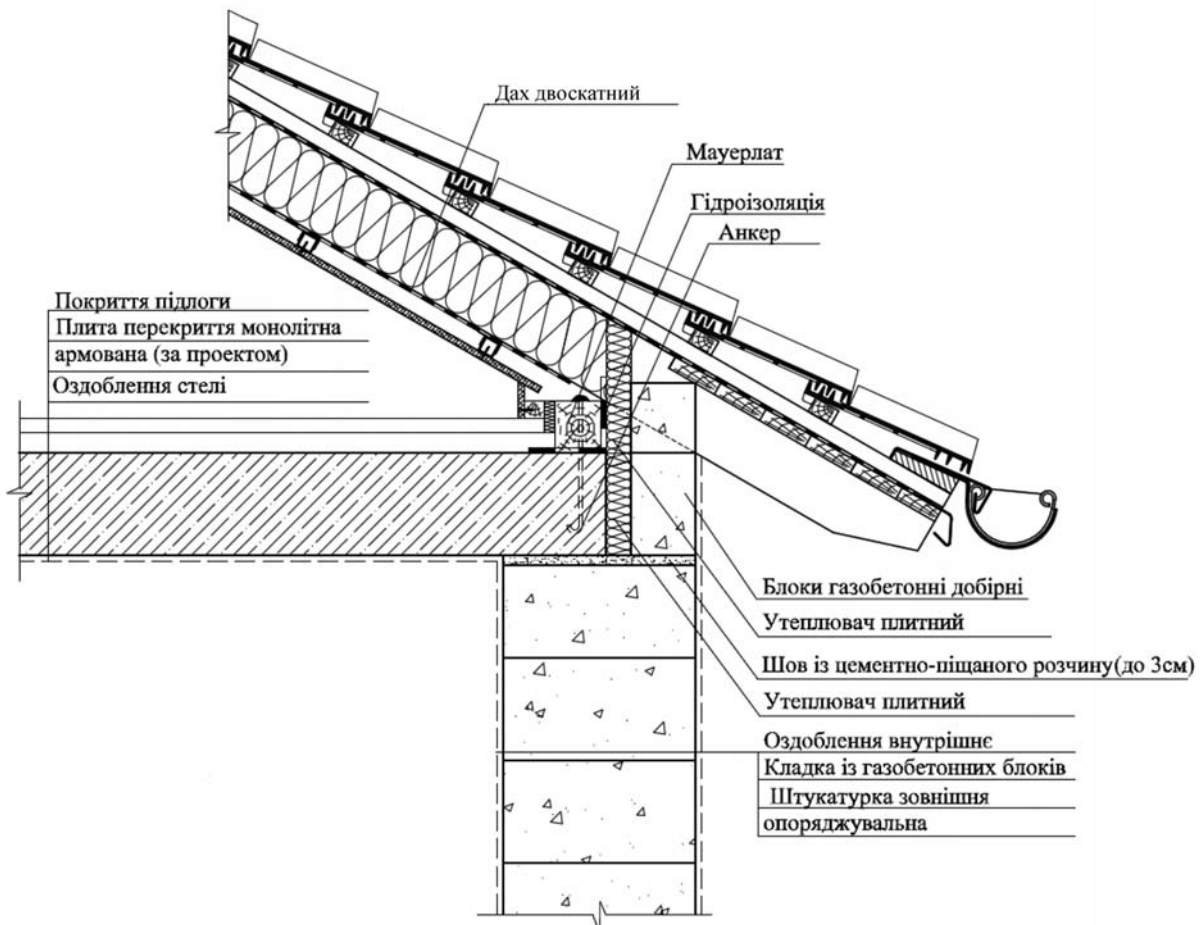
Вузол обпирання даху на газобетонні стіни на рівні горищного монолітного перекриття на газобетонні стіни
